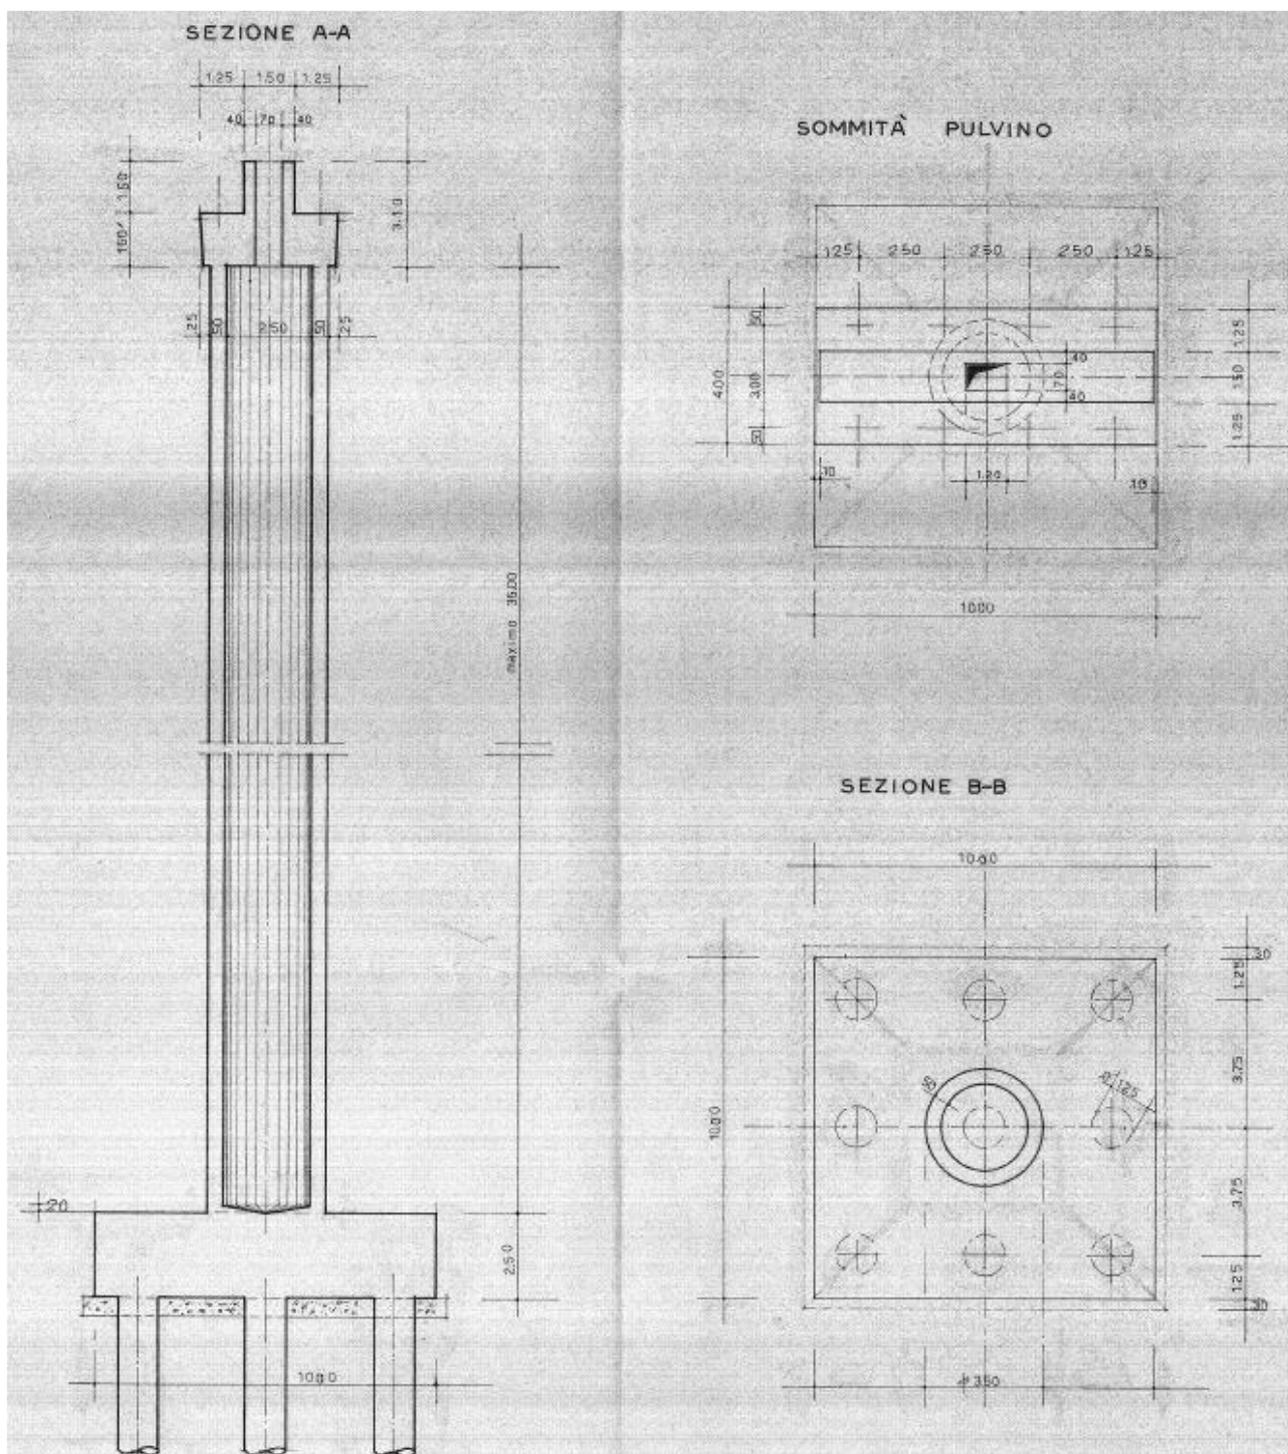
Impalcato a 4 travi in CAP – Sezione trasversale e pianta pile e pulvini
